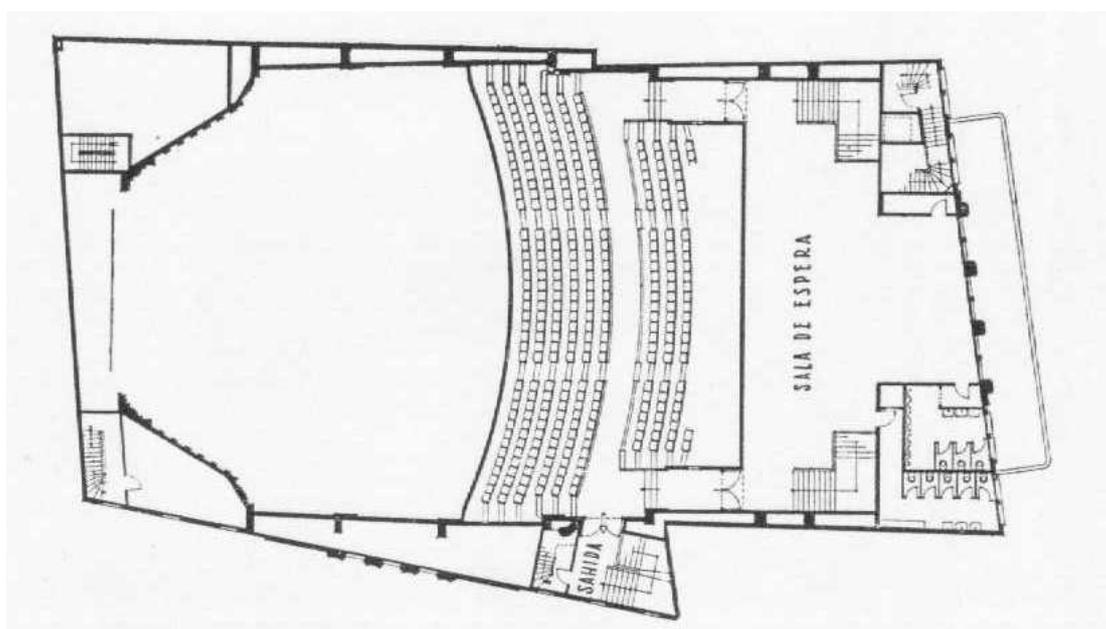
Cine Metro São Paulo - Planta do pavimento superior (balcão).
